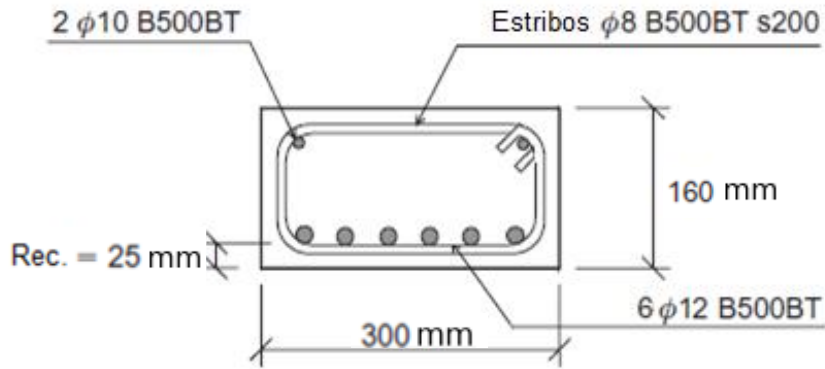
Secção transversal, viga B140. Adaptado de [4].
